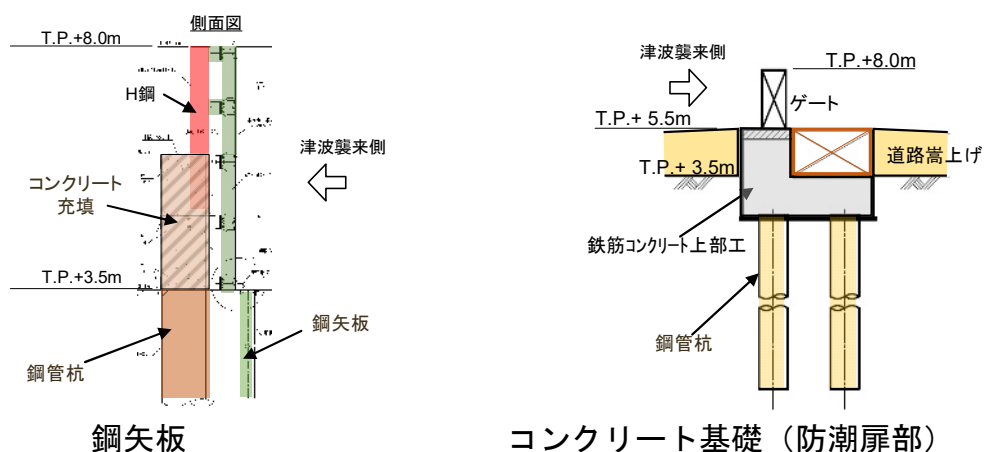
放水口側防潮堤および防潮扉詳細断面図
